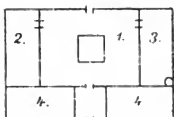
Kräuter- und Gemüsegarten in Verbindung mit der Gärtnerwohnung auf dem Grundrisse des Klosters St. Gallen.
